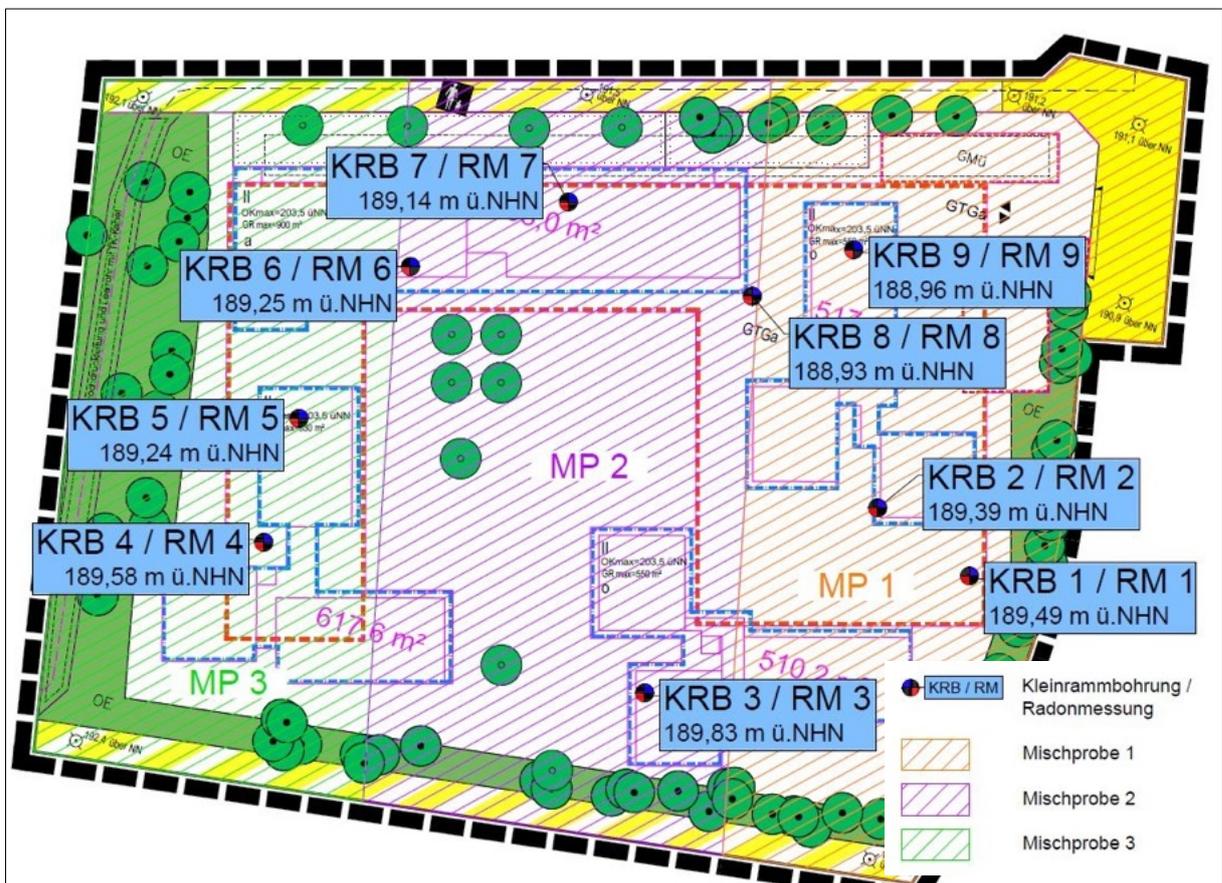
Lageplan Radon-Untersuchungen (GUMM 2020)
